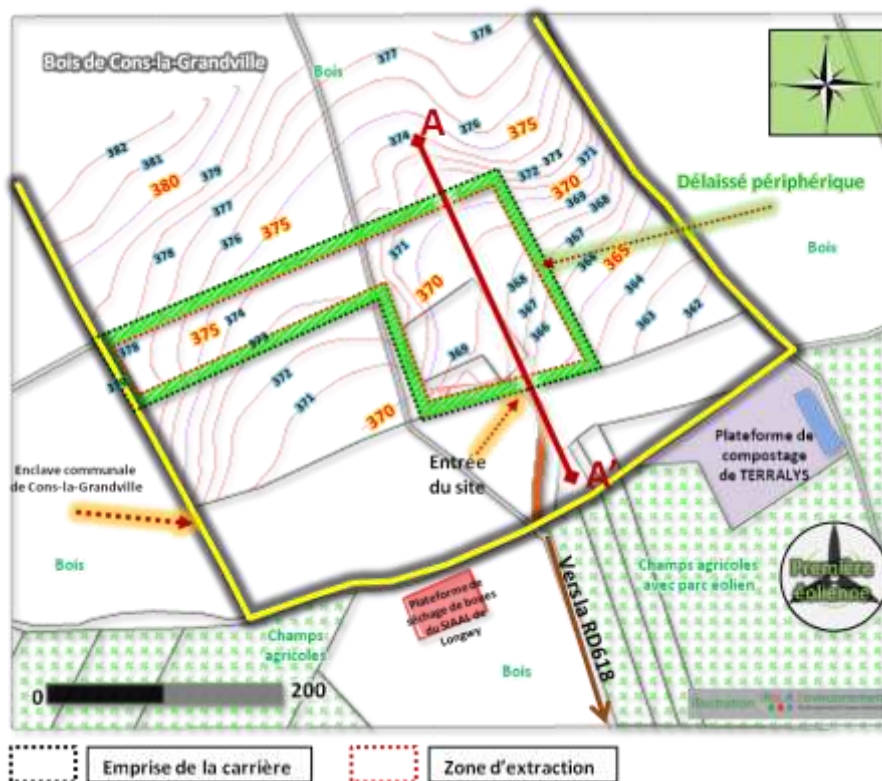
Plan topographique avec tracés de coupes (emprise du site)
